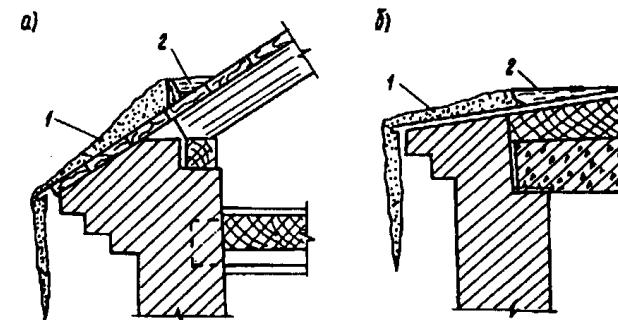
Схема образования протечек кровли при нарушении теплового режима чердака и бесчердачного совмещенного покрытия (а — в зданиях с чердаком; б — в бесчердачных зданиях):
